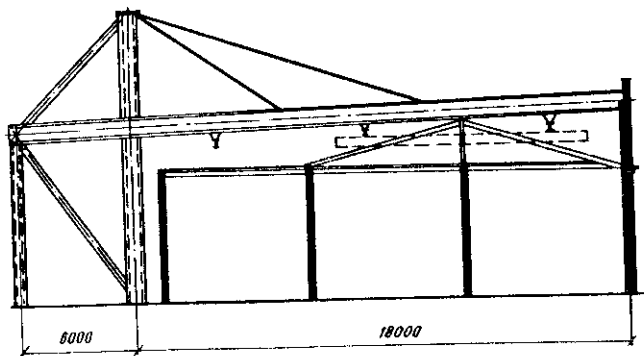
Использование консольно-вантовой схемы покрытия для реконструкции в стесненных условиях (автор А.С. Щеглов)
